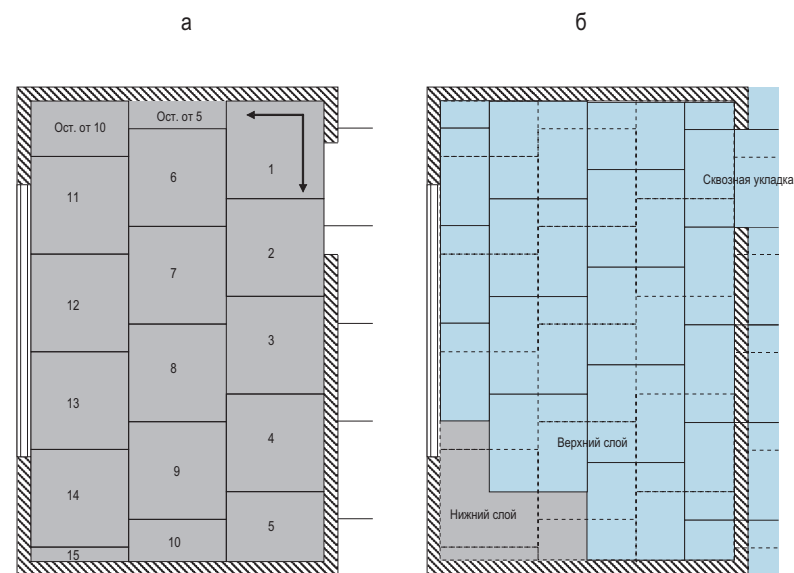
Схемы раскладки малоформатных ГВЛВ: а – нижний слой, б – верхний слой
